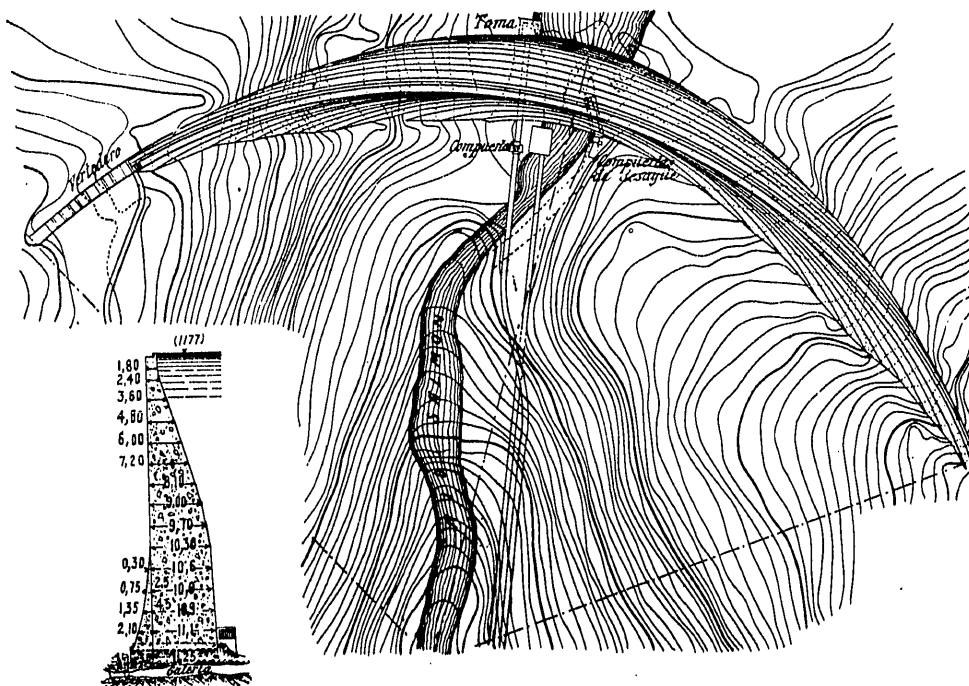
ª Planta y perfil de la presa de Salmon Creek.
